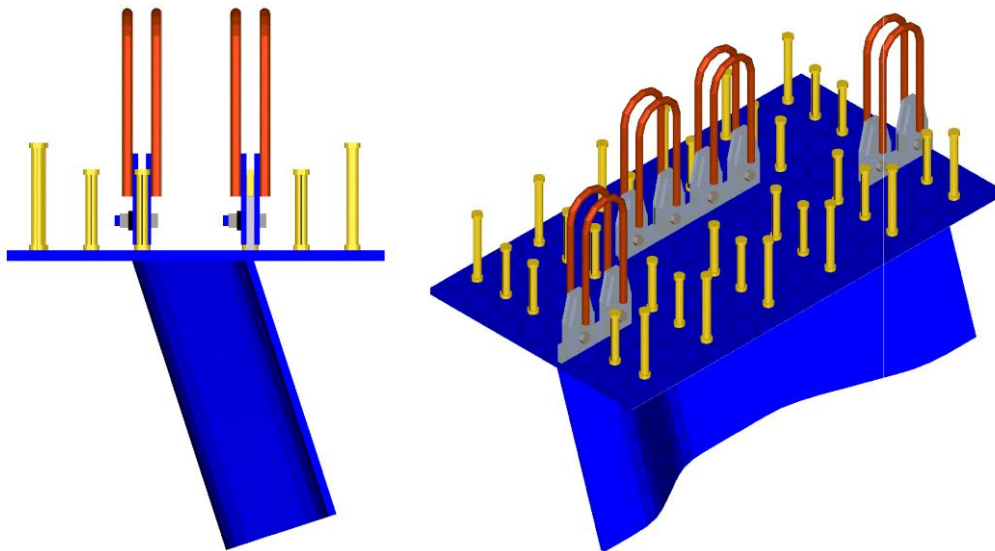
Ausbildung der Verbundfuge der Talbrücke Altwipfergrund am Anschluss zum Stahlbetonobergurt
